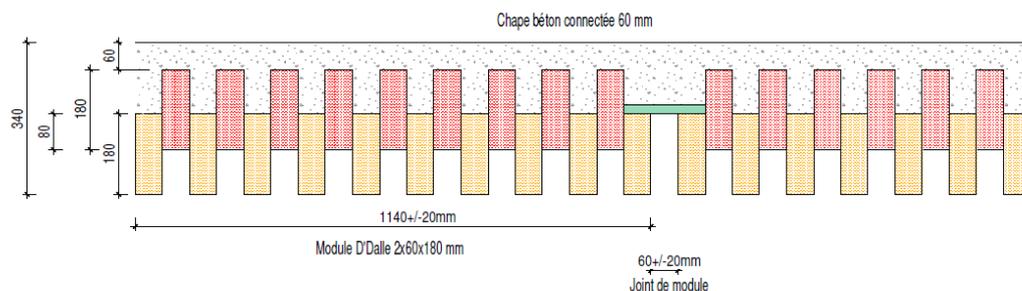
D-Dalle®, la double dalle mixte bois-béton, pour des portées de 11 m à 18 m
